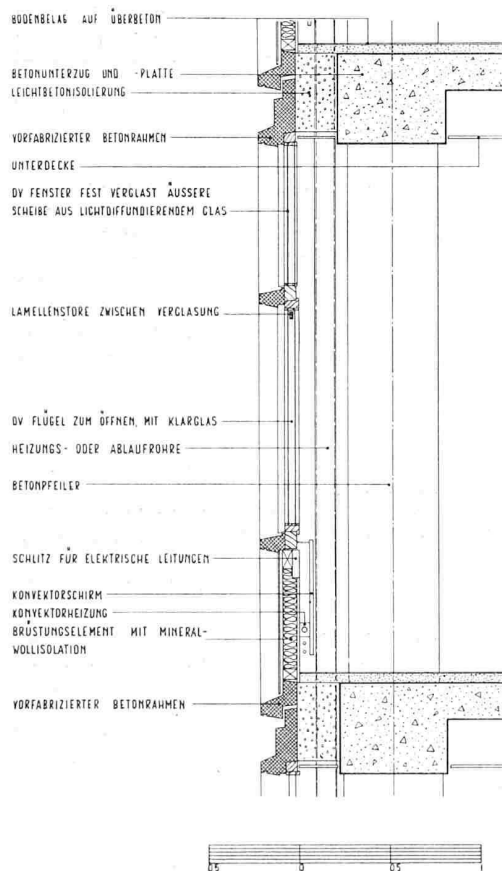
Fassadendetail mit vorfabrizierten Betonelementen, Masstab 1:40
